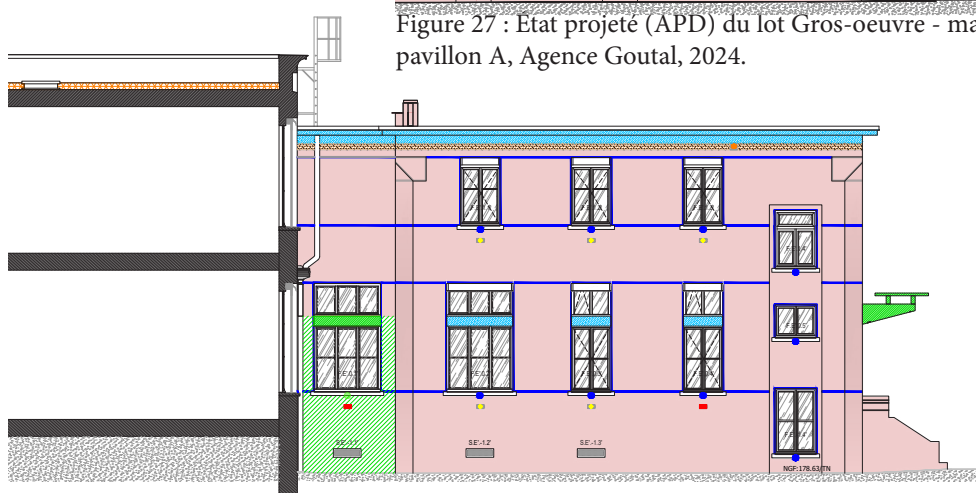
État projeté (APD) du lot Gros-oeuvre - maçonnerie - pierre de taille, coupe-élévation Est, pavillon A, Agence Goutal, 2024.
